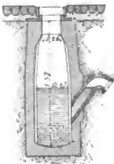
Einlauf aus gebranntem Ton. M. 1:50.
